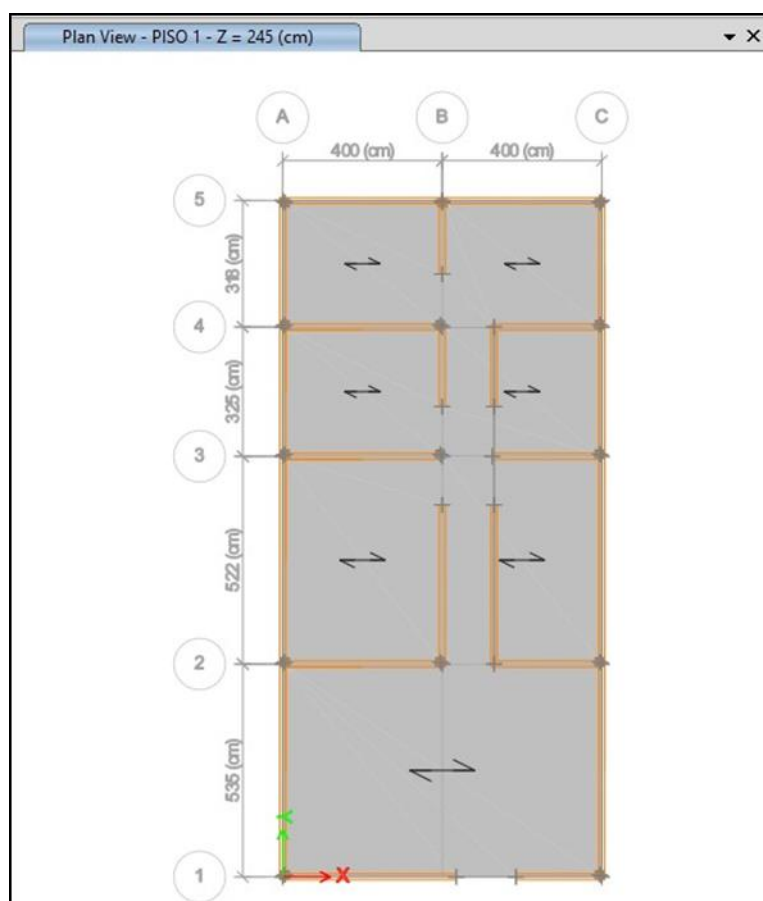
Modelamiento en planta de la Edificación. Tomado de Elaboración Propia.
